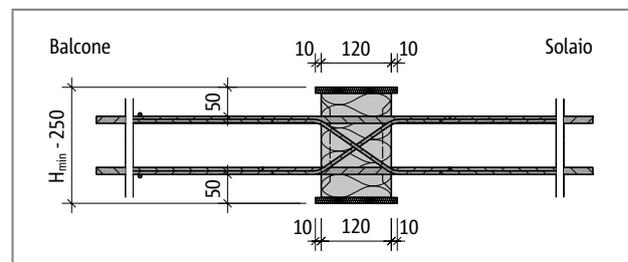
Schöck Isokorb® tipo DXT-CV50, REI120: sezione dell'elemento
